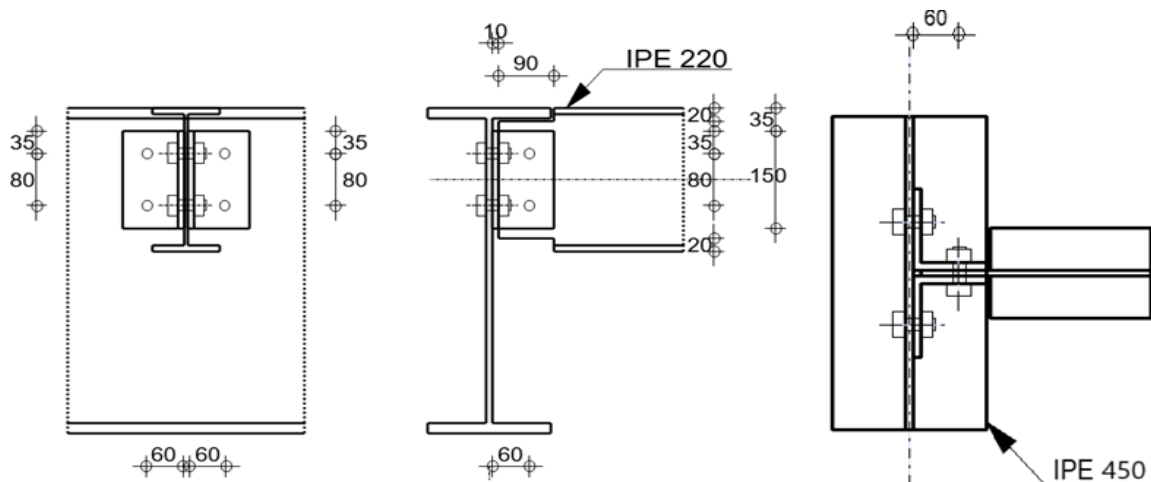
Disposition constructive de l'assemblage poutre- solive.
